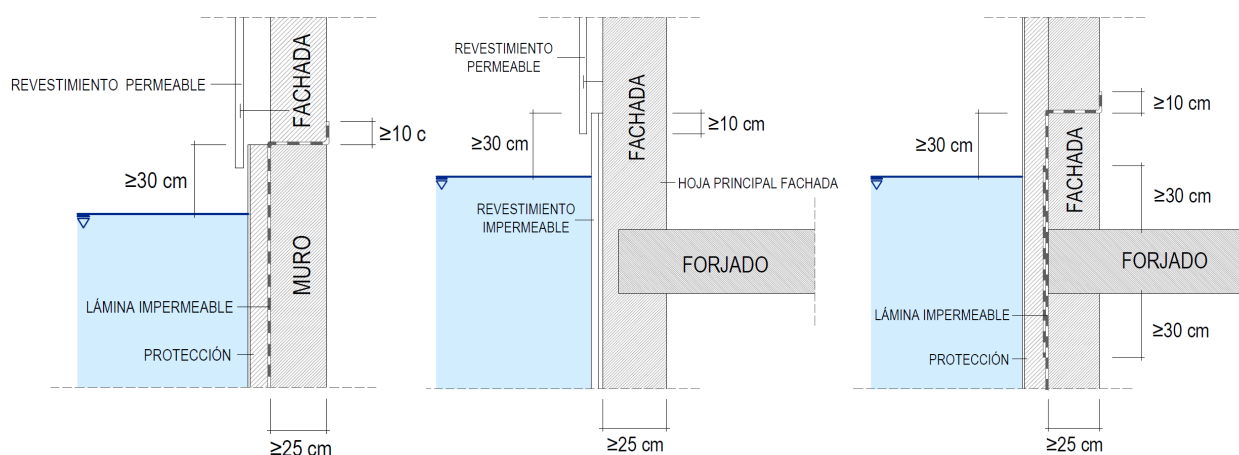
Encuentros de la fachada o muro con el forjado bajo el nivel máximo de inundación.
